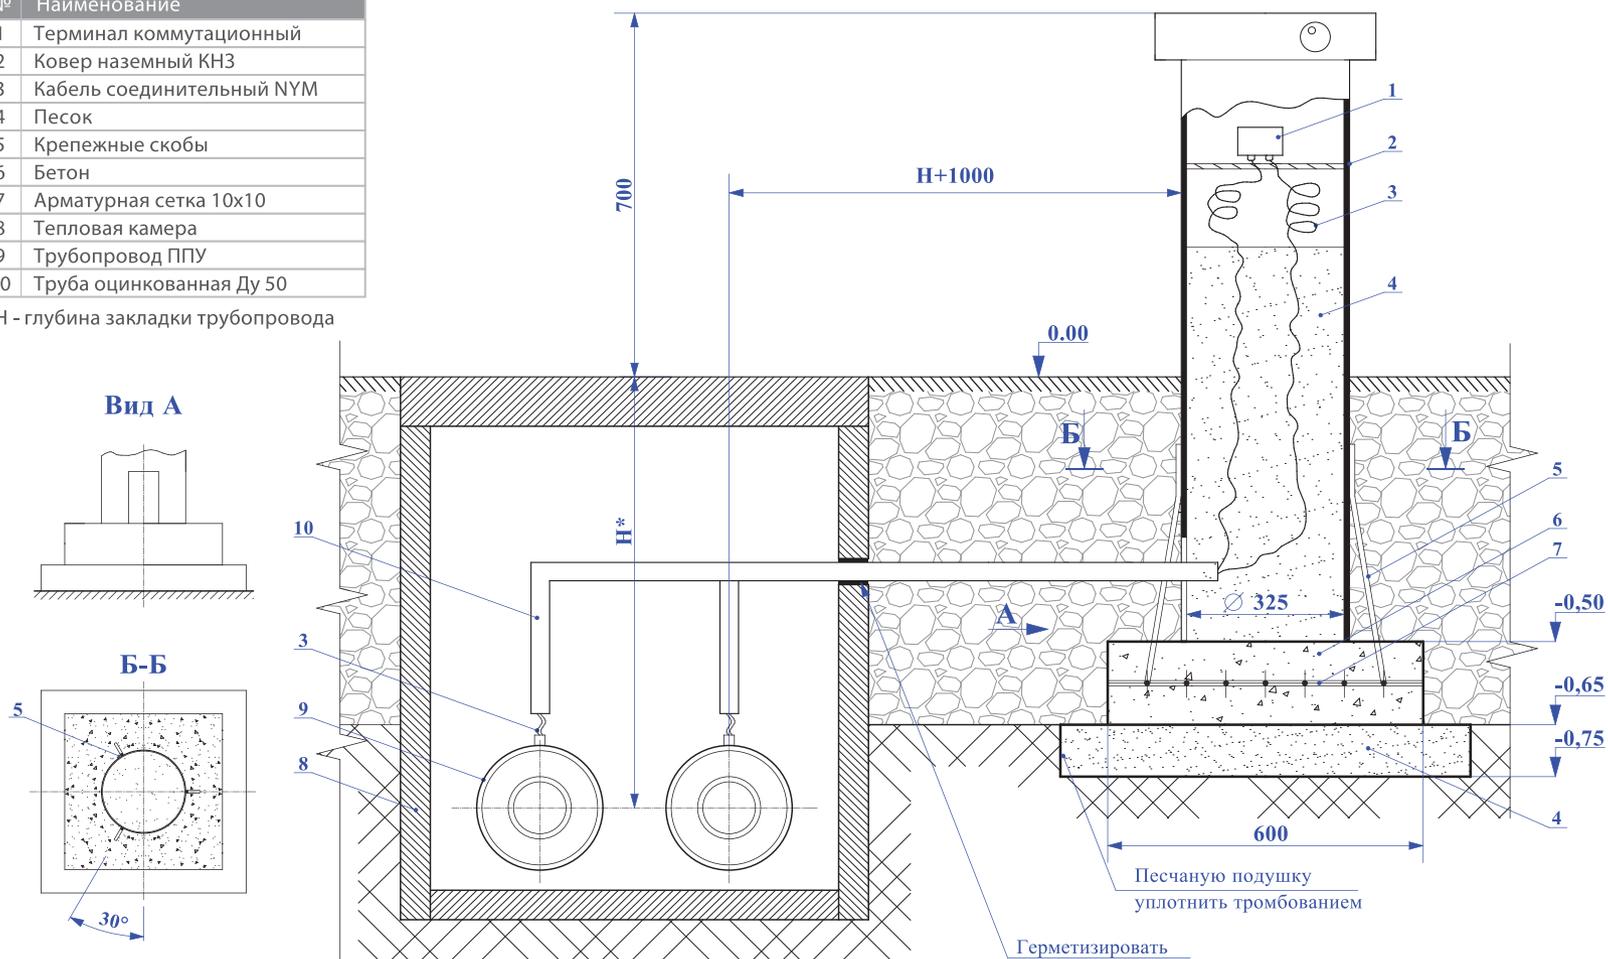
Монтажная схема установки ковра наземного КНЗ в концевой ТК рядом с тепловой камерой
